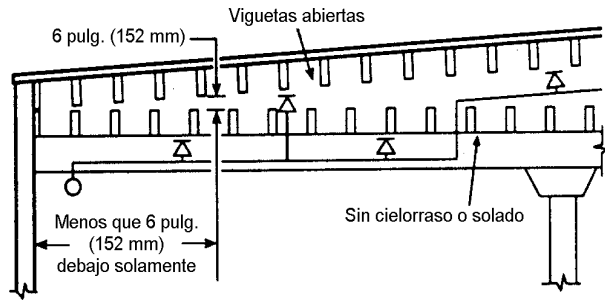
Disposición de los rociadores debajo de dos juegos de viguetas abiertas. No existe revestimiento en las viguetas inferiores.
